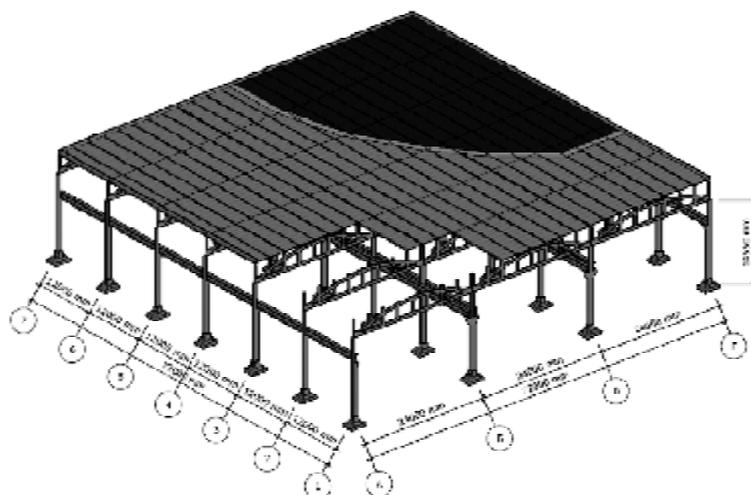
Вариант каркаса одноэтажного промышленного здания с шагом колонн в продольном направлении – 12 м (иллюстрация авторов)
